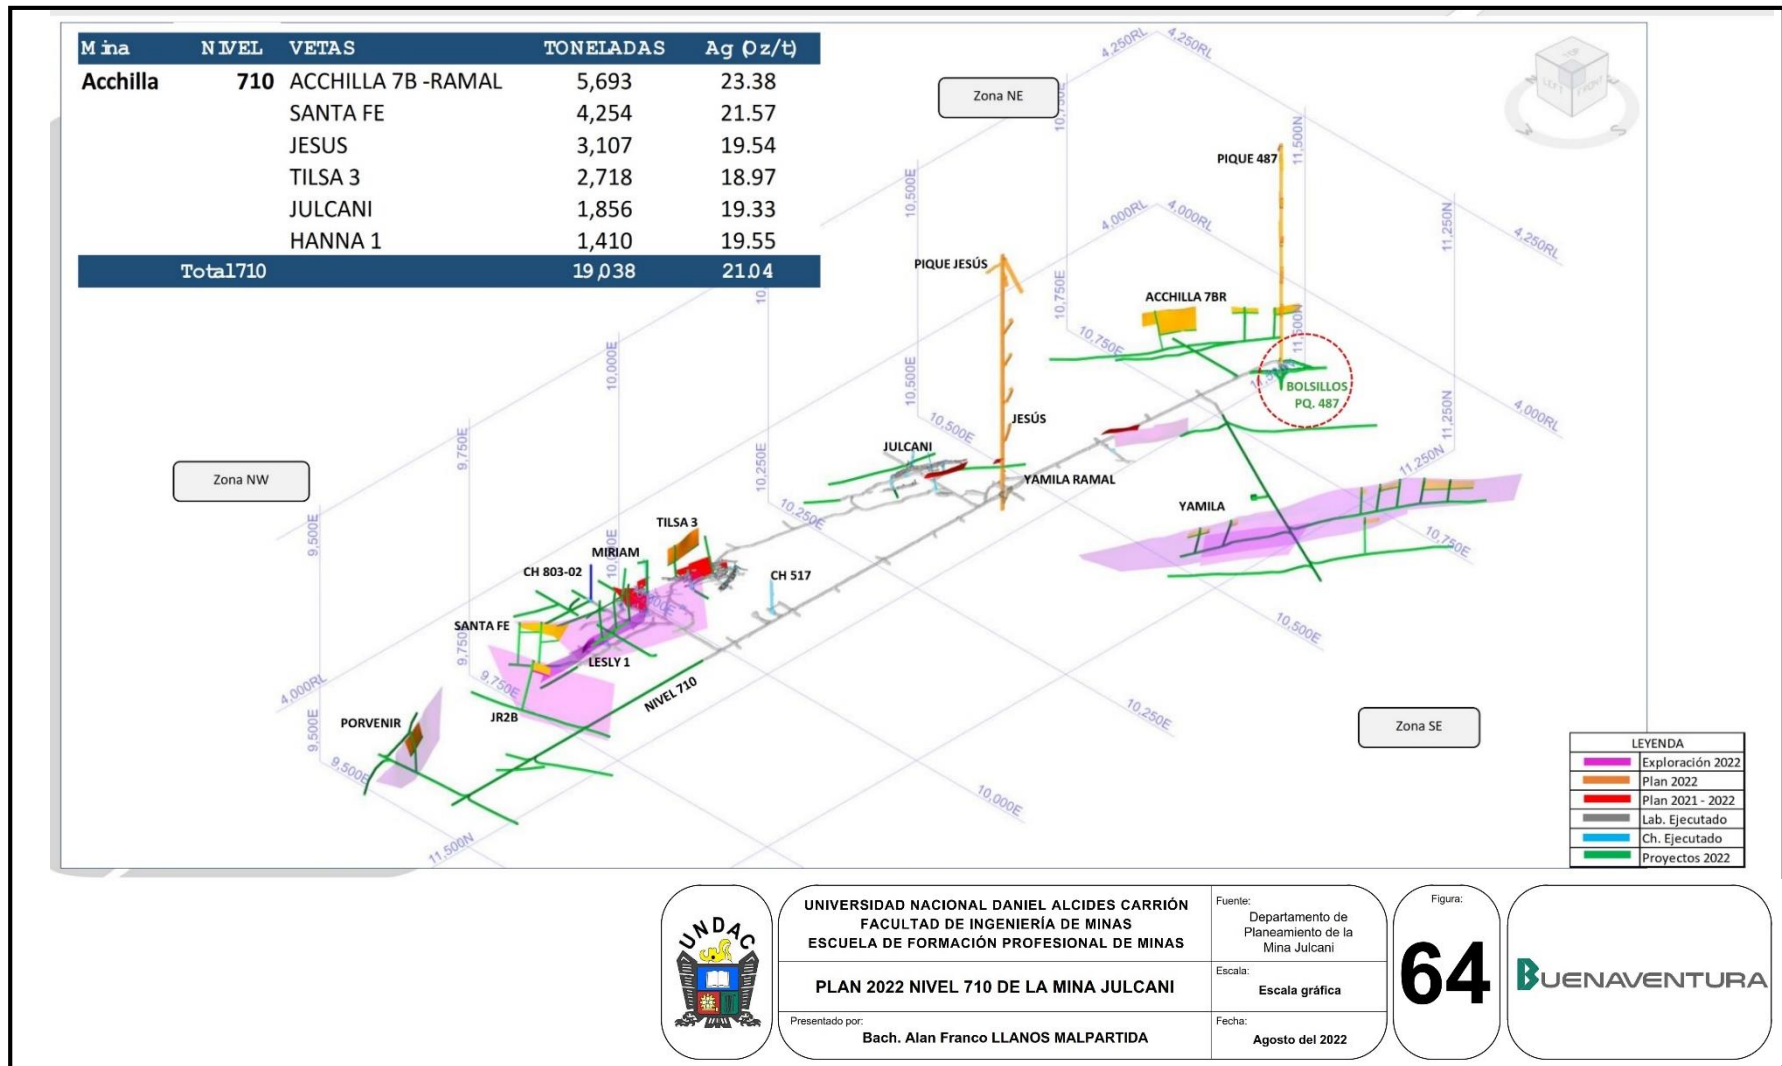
Plan 2022-Nivel 710 de la Mina Julcani.
